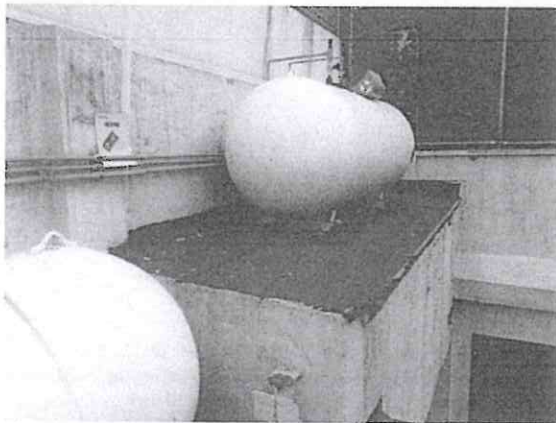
y 16. Tanque de gas ubicado en la zona de acceso de suministros, apoyado sobre una losa inclinada. Se recomienda complementar su fijación con elementos adicionales sujetos al muro. Lo anterior para evitar su probable caída durante algún eventual movimiento sísmico.
